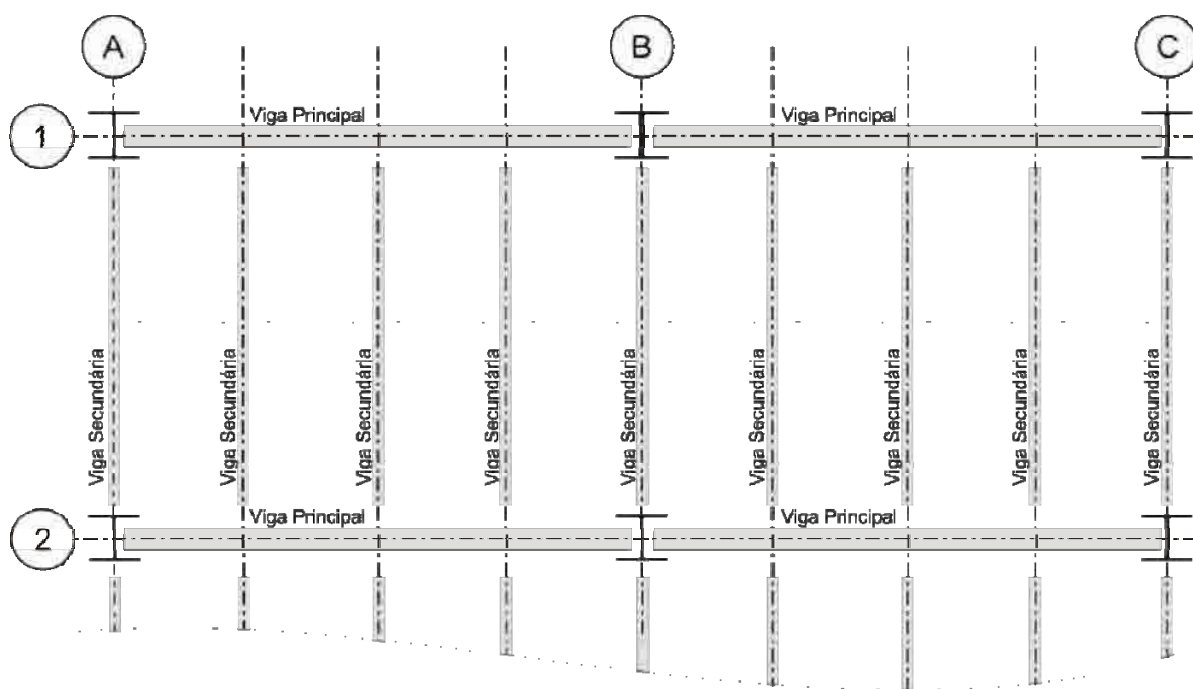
Arranjo típico de um sistema de piso de um edifício de múltiplos andares em estrutura metálica, com disposição de vigas secundárias e principais.
